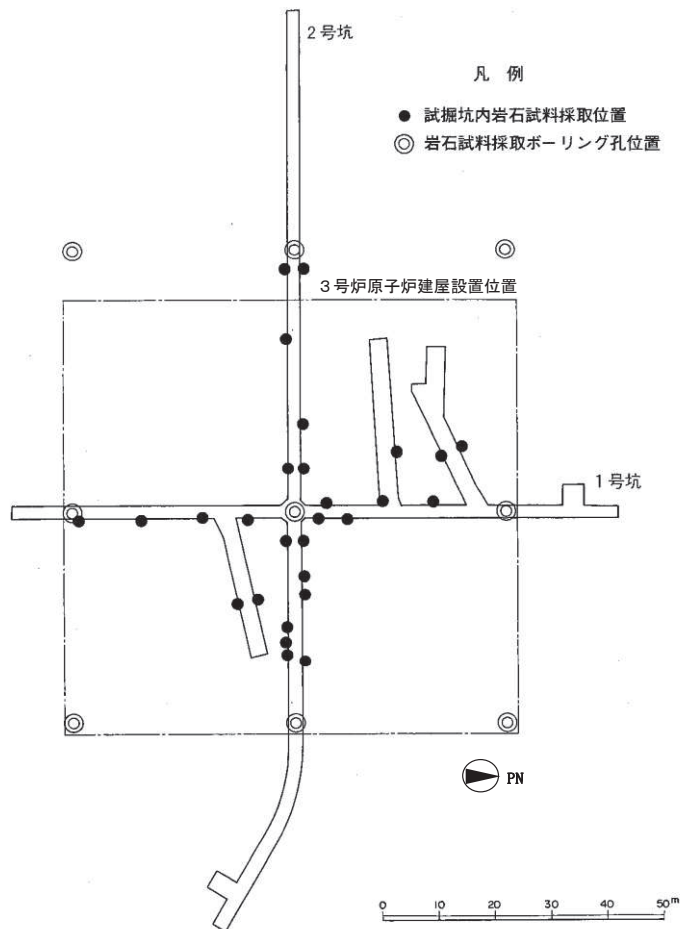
(2) 試料採取位置 (第3号機原子炉建屋, 牧の浜部層)
